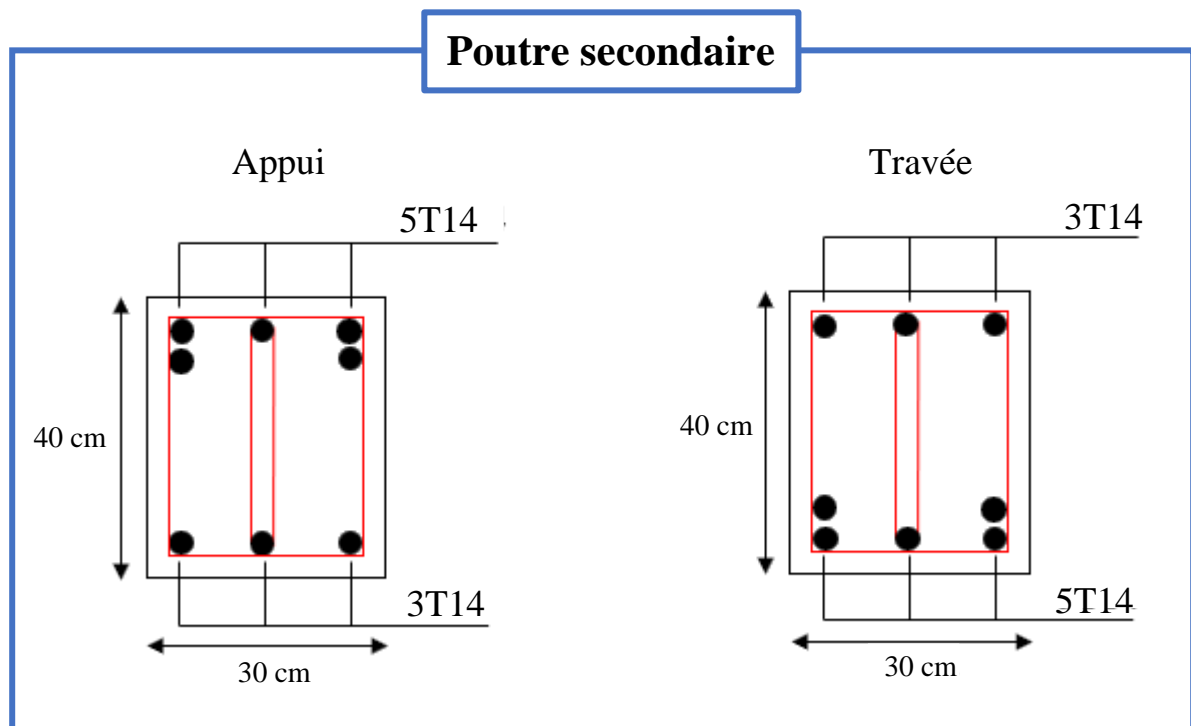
Schéma de ferrailage des poutres secondaires (RPA/v24).
